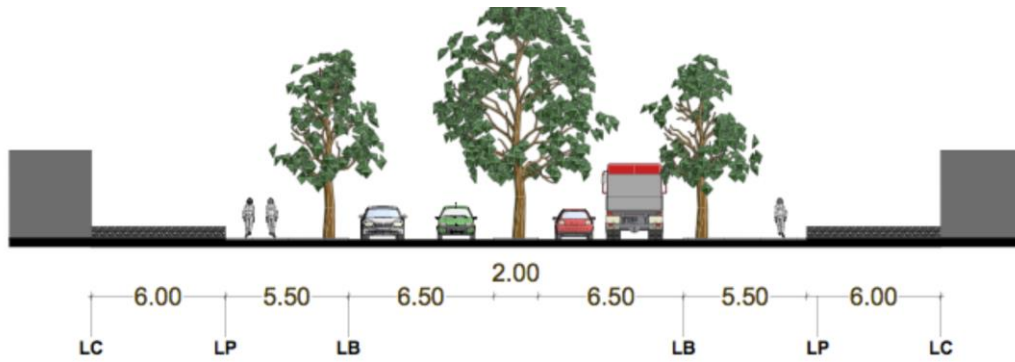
Perfil vial tipo V3. Adaptado del POT Barranquilla, 2008.
